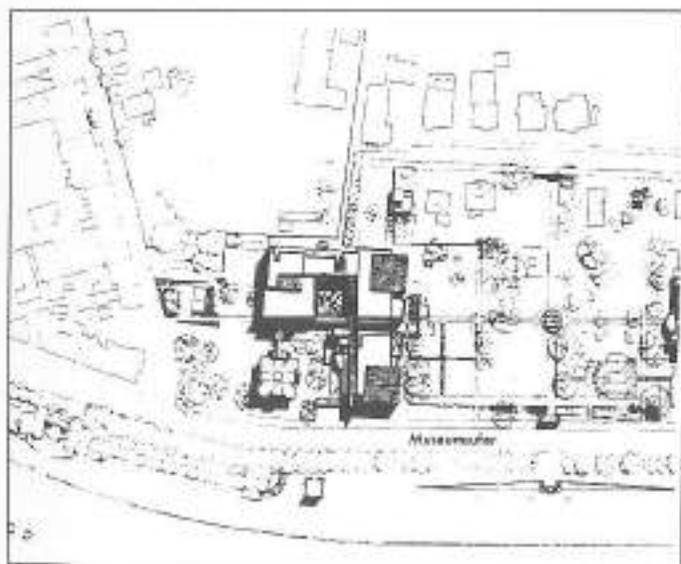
Francoforte. Il museo delle Arti e Mestieri di Richard Meier. Planimetria generale.
